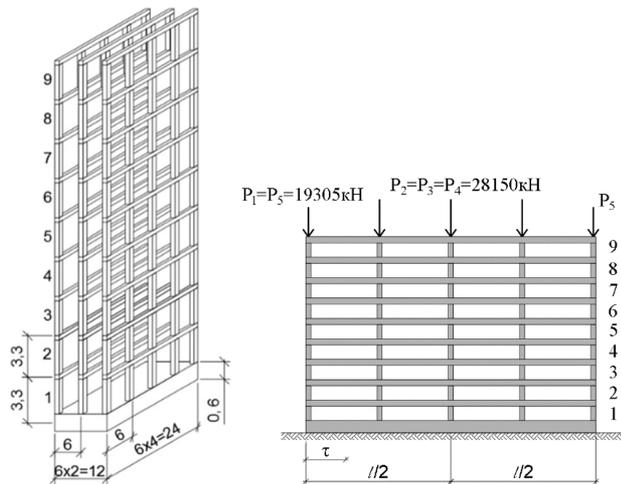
Каркасное 9-этажное здание (общий вид и расчетная схема многослойной составной балки свободнолежащей на упругом основании)
